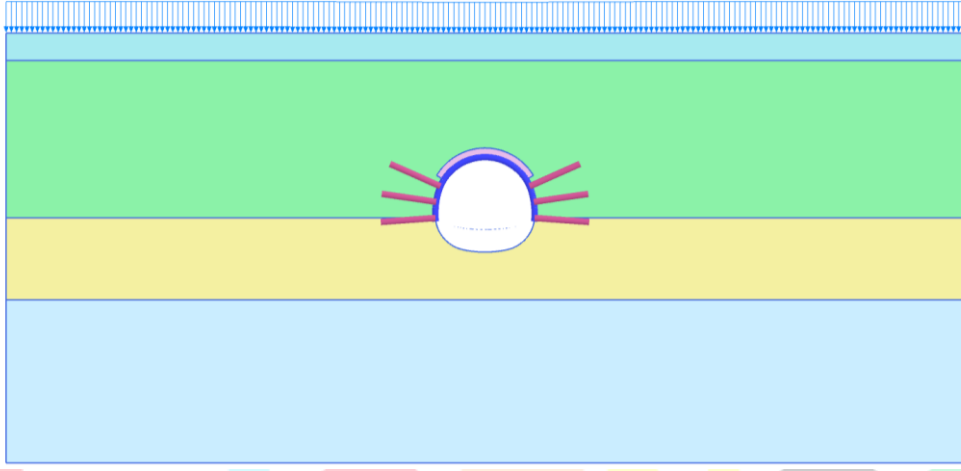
Faz-3: Üst Yarı Kazısının Yapılması
